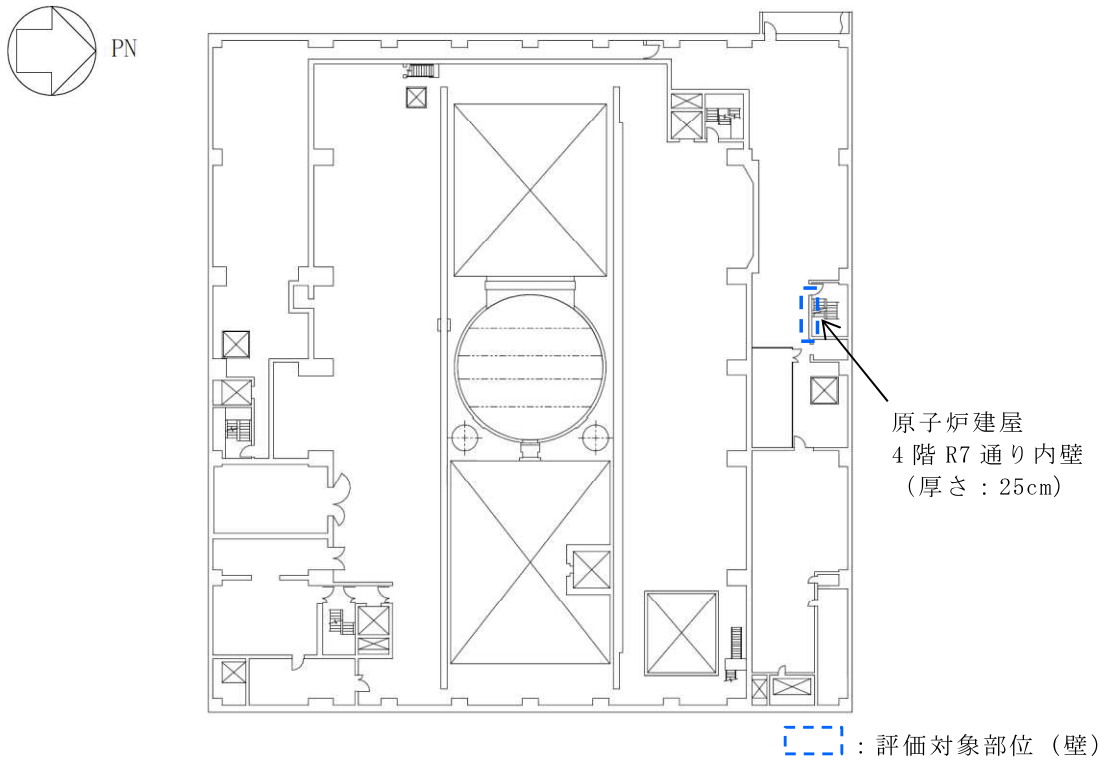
原子炉建屋の概略平面図 (T. M. S. L. 31.7m) (2/2)
